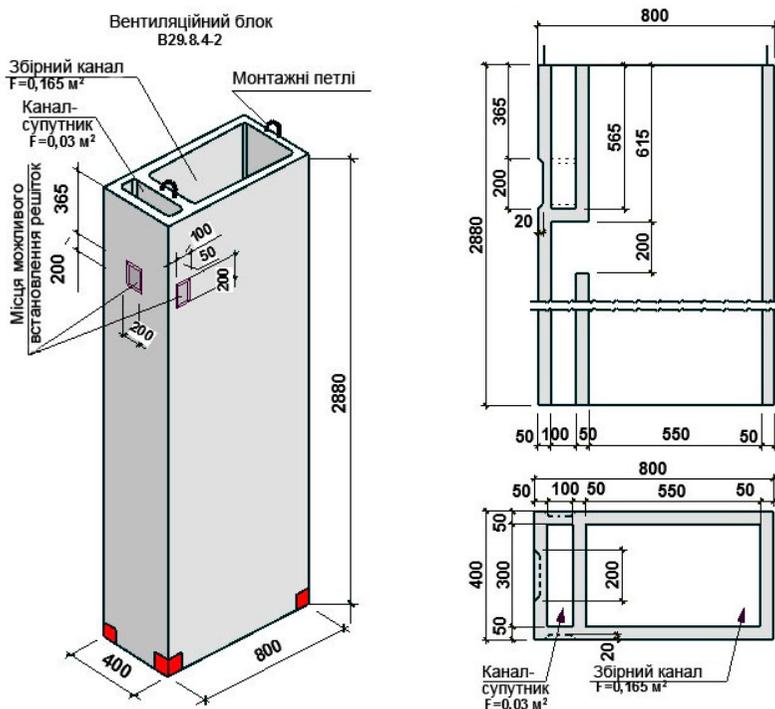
Уніфікований залізобетонний вентиляційний блок
